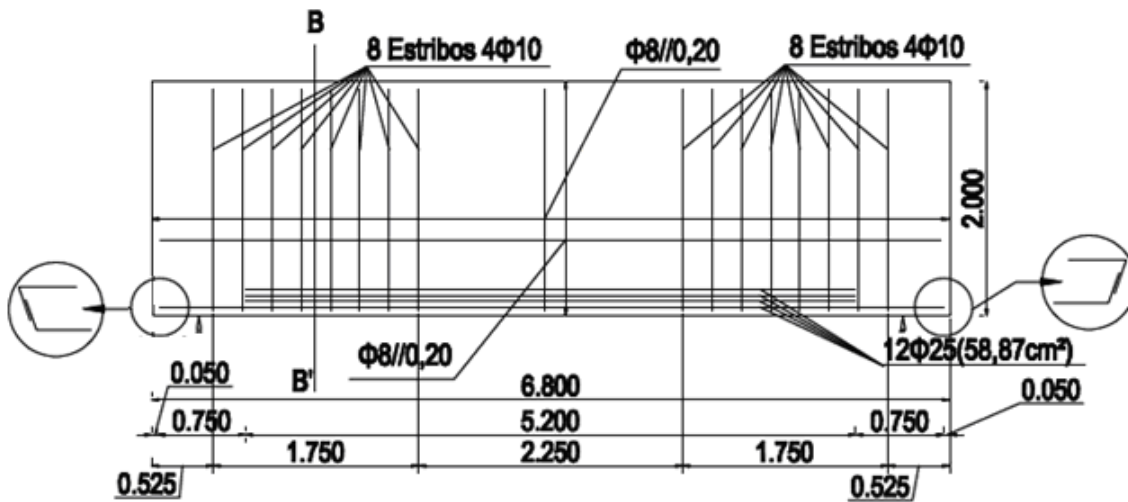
Pormenorização das armaduras da viga-parede, modelo alternativo.
